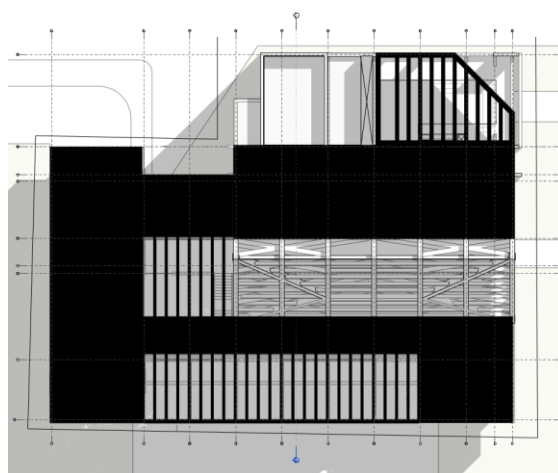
Vista en planta propuesta arquitectónica, se aprecia la geometría de carácter racional
